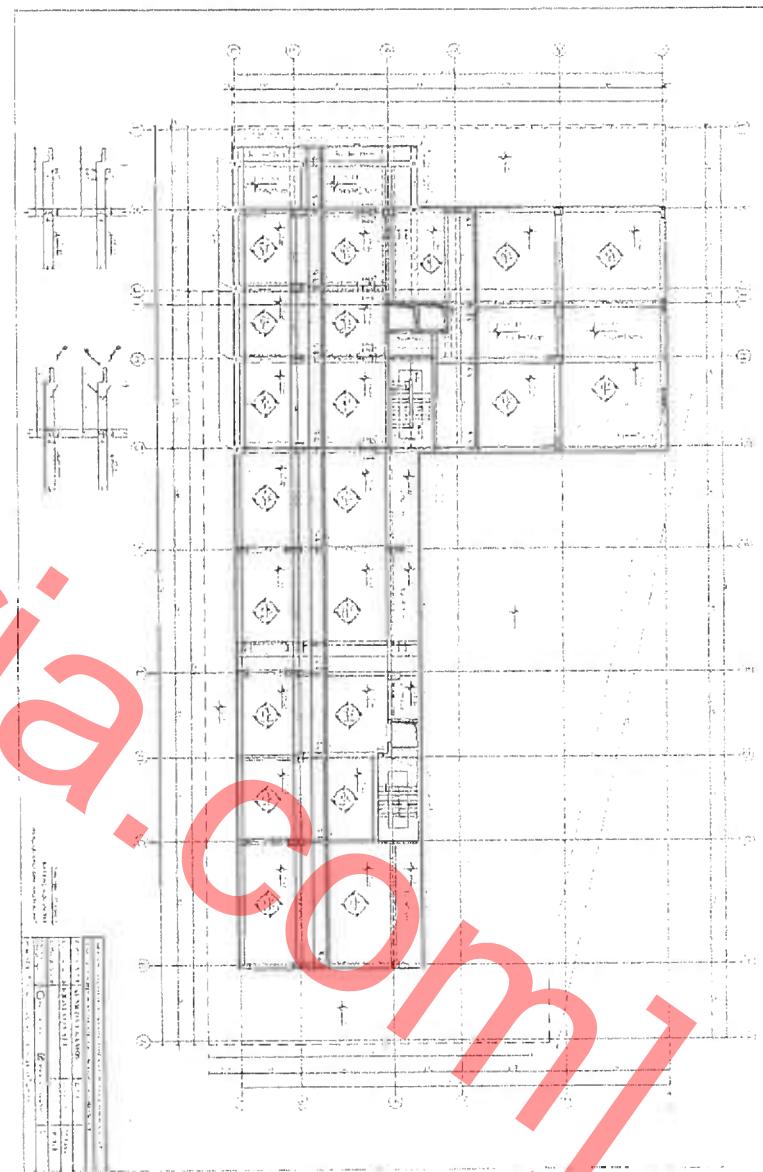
Plan i Strukturave ne Kuoten +8,91 m, Plan i Kallepit
